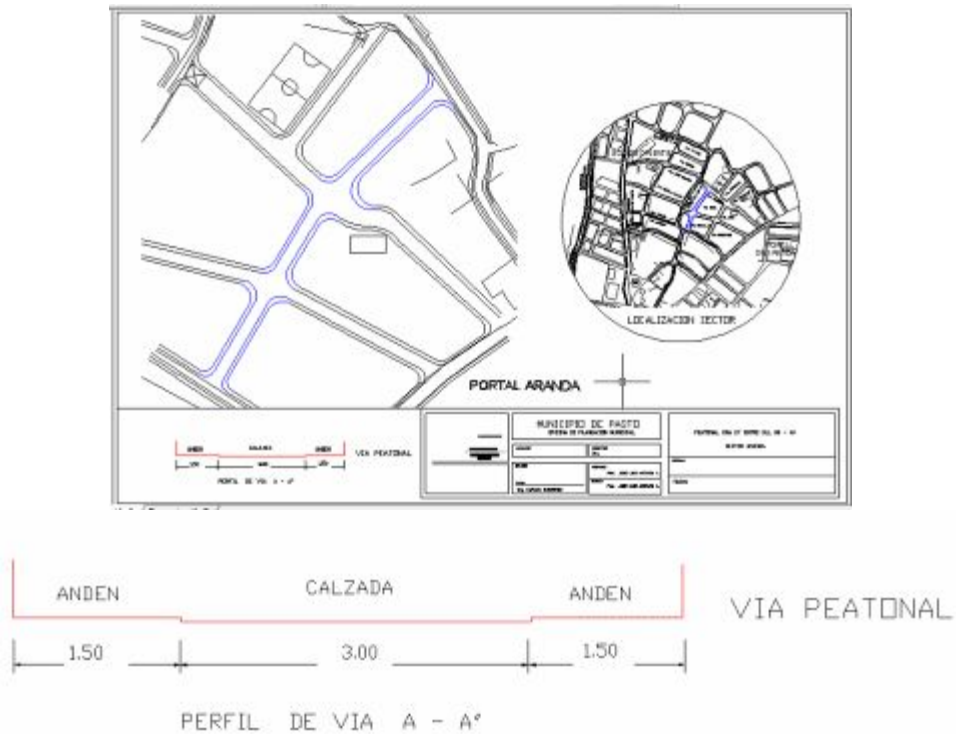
Planta y sección transversal carrera 27 entre calle 37 y 40
